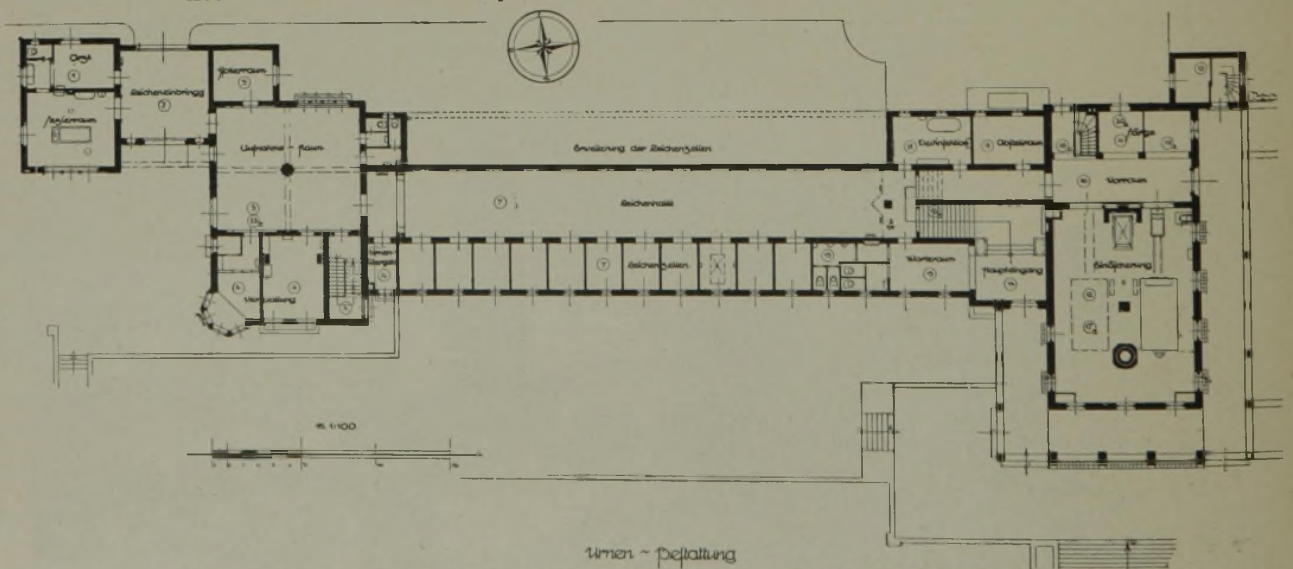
Erdgeschoßgrundriß des Krematoriums. (1 : 500)
